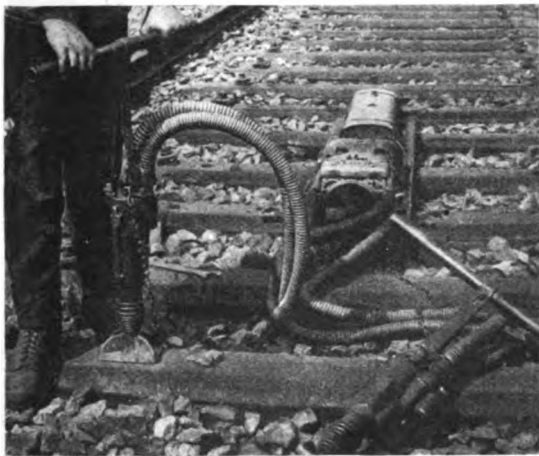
Zum Stampfen umgebaute Kruppsche Gleisstopfmaschine.
